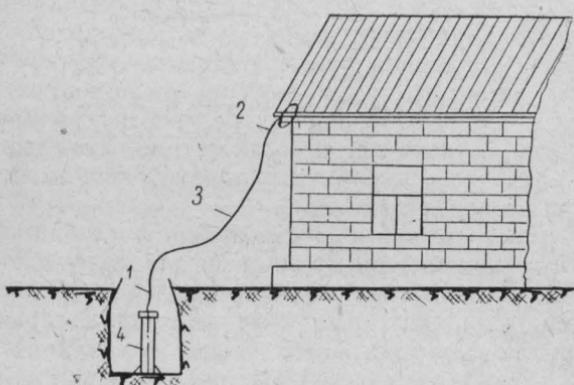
Заземление металлической кровли здания с помощью зажимов:
